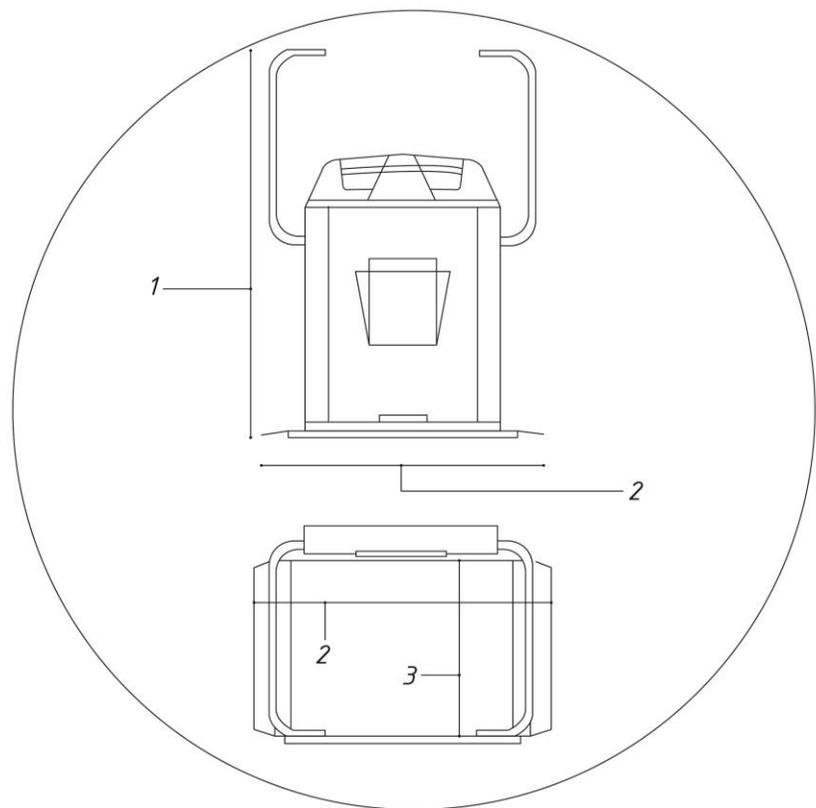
Detalle plataformas de elevación verticales e inclinadas. (C4)
